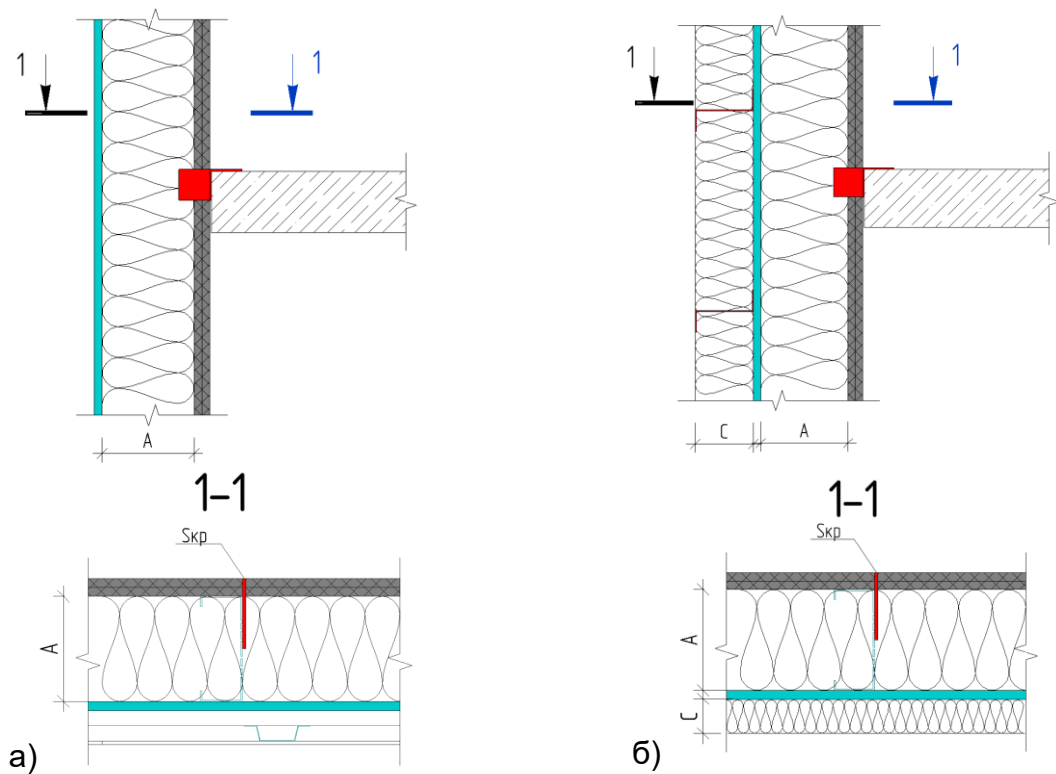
Схеми вузлів кріплення навісних ПСК на каркас: а) ПСК без додаткового утеплення б) ПСК з додатковим утепленням
